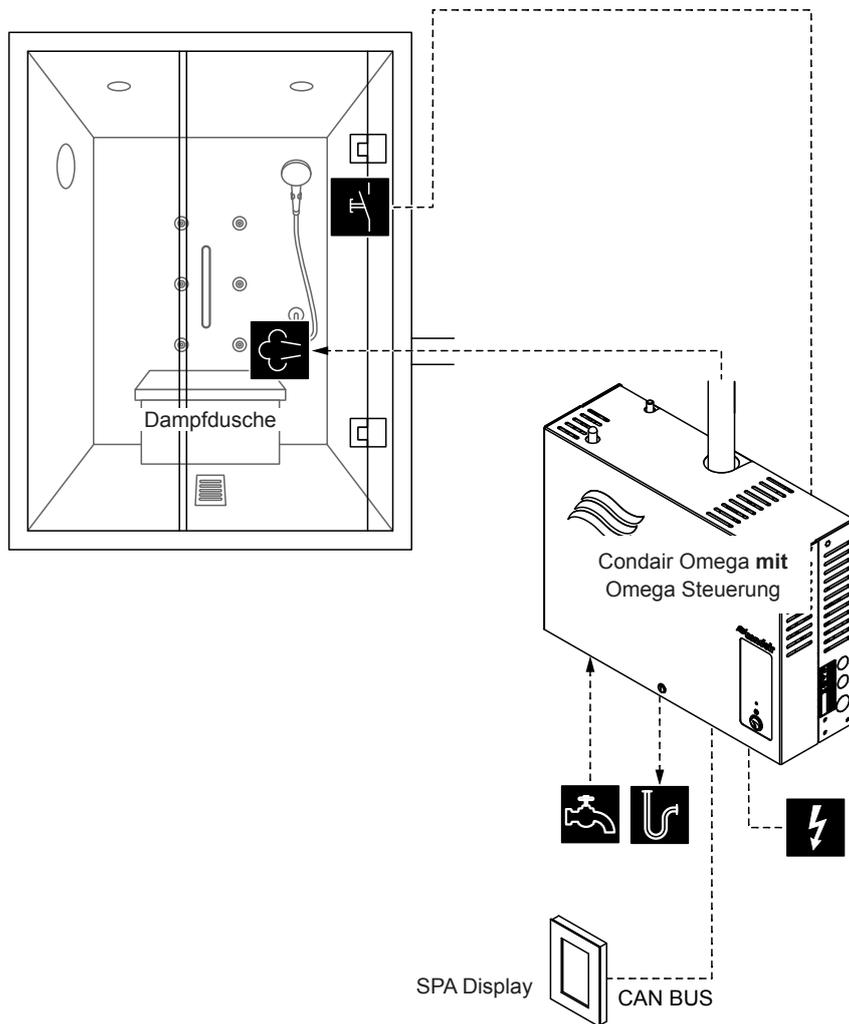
Condair Omega mit Omega Steuerung für Dampfduschenanwendung, Betrieb mit konstanter Dampfproduktion
